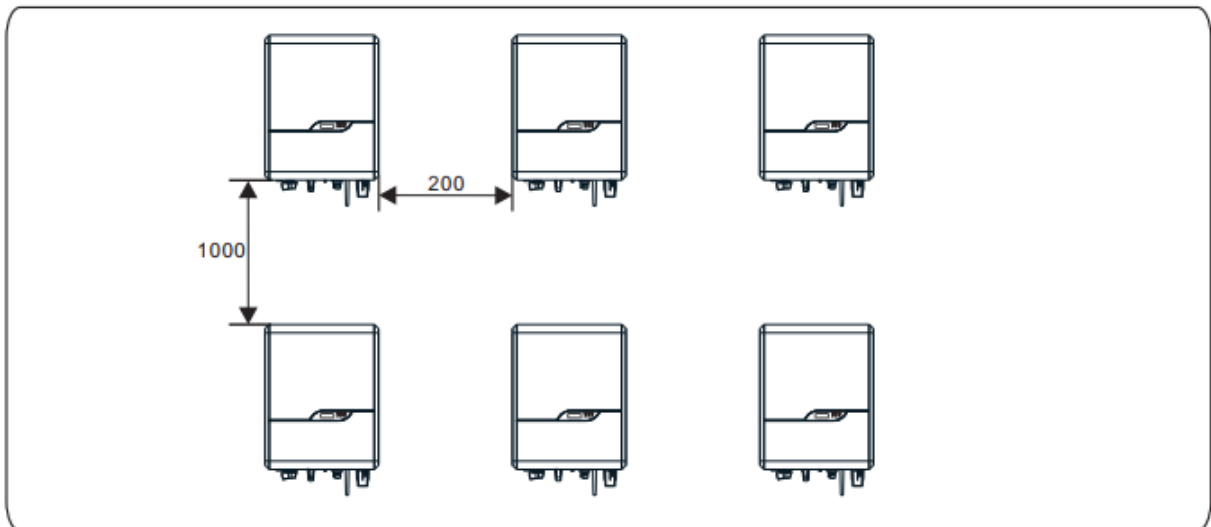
Installazione in modalità sovrapposta (unità: mm)
